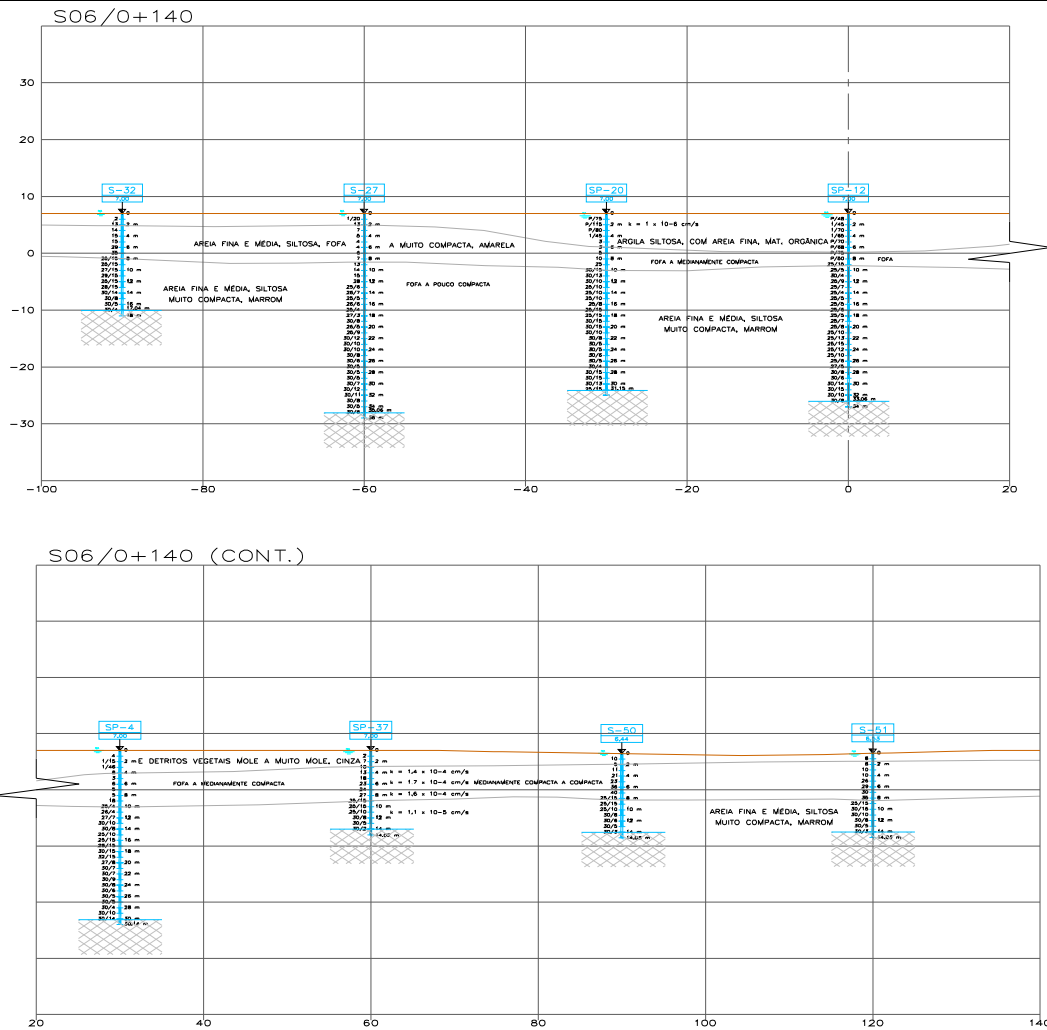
Seção transversal 06 do maciço de fundação da Barragem de Santa Helena
